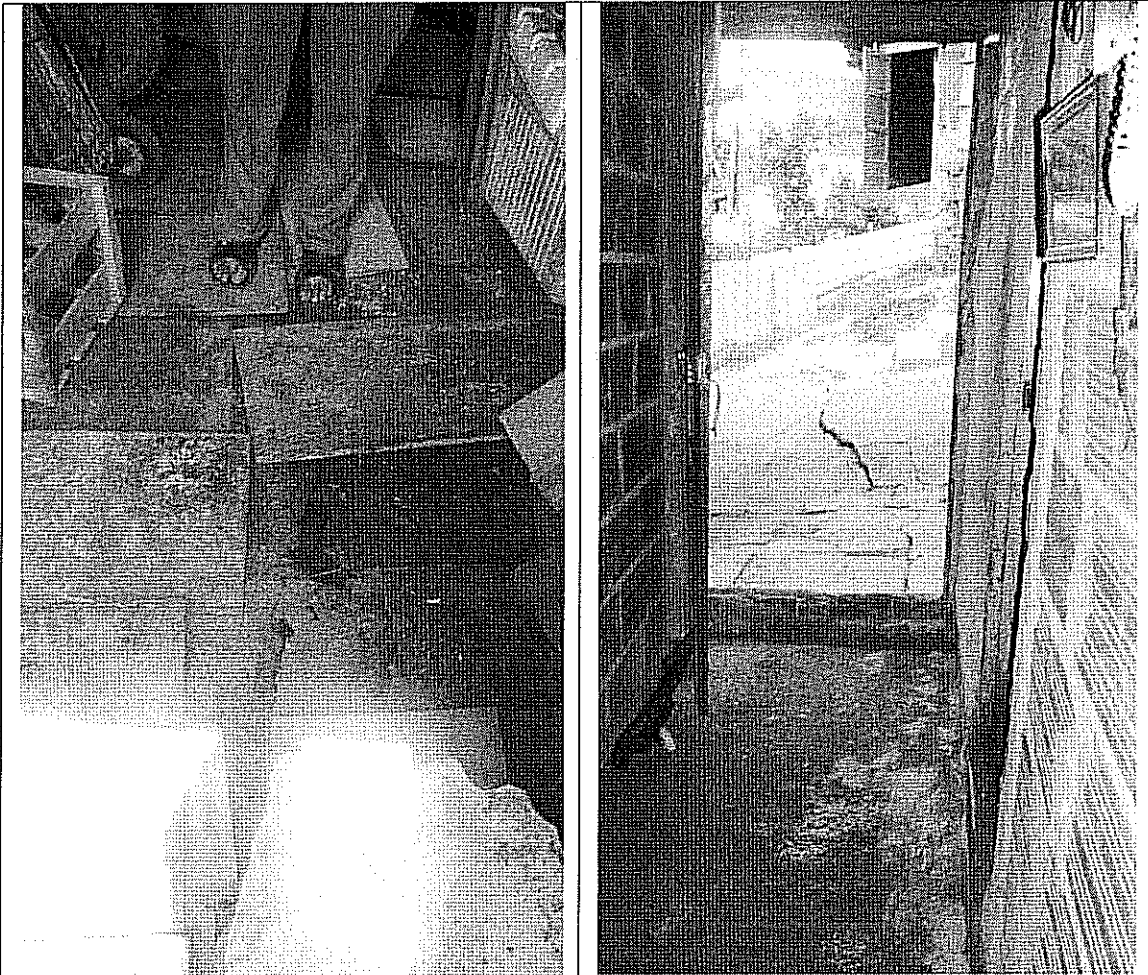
Agrietamiento de las placas de pavimento rígido de la Carrera 16B Bis, las cuales evidencian el desplazamiento del material de soporte.
